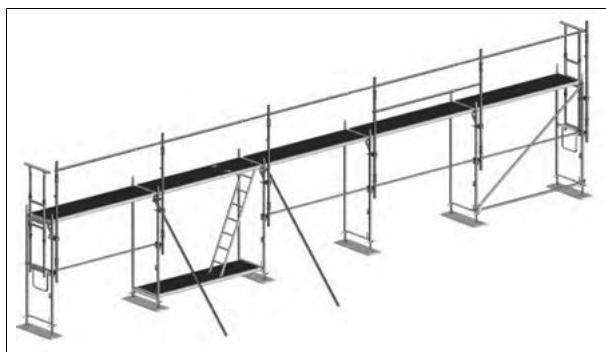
Vorübergehende Kippsicherung der 1. Gerüstlage mit Gerüstrohren
